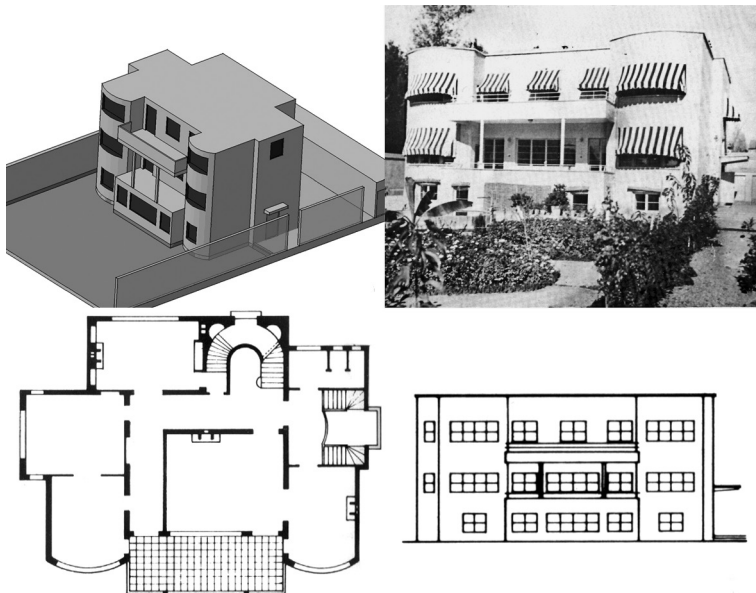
Villa Panahy, Teheran. Gabriel Guevrekian 1935. Isometrie, Grundriss erstes Obergeschoss, Foto und Aufriss Gartenseite.
